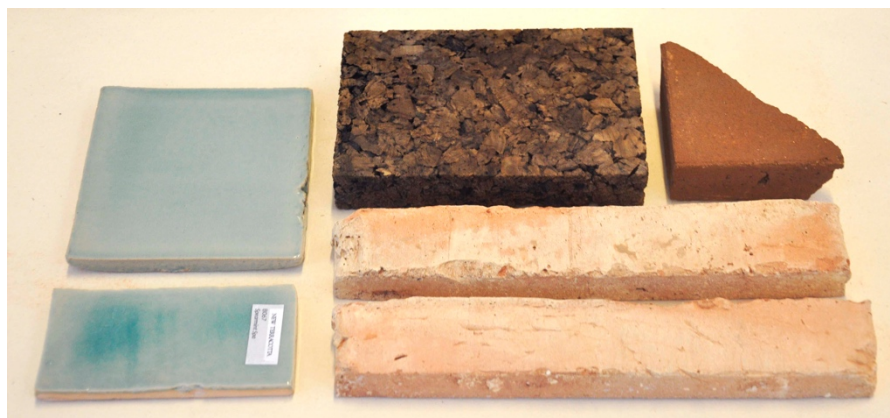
Azulejo vidrado em tons de verde; Cortiça para a parede das salas de aula e amostra de tijoleira terracota para o pavimento dos espaços exteriores.
